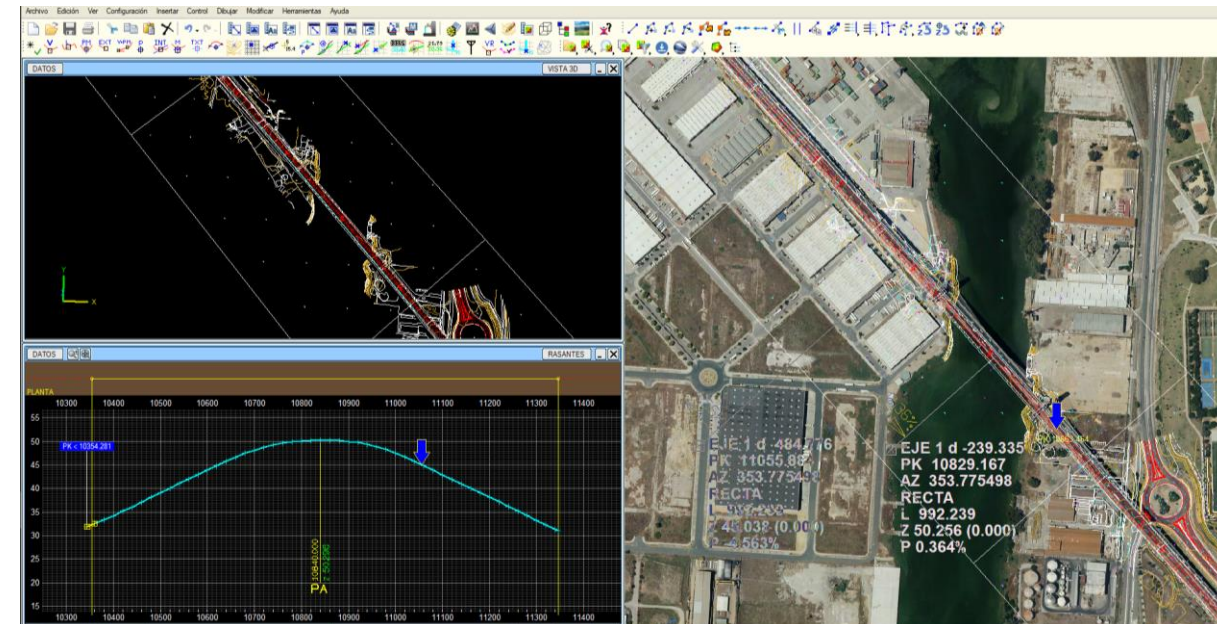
Imagen de la geometrización en planta y alzado del eje definido para la actuación, en el programa Istram-Ispol.
